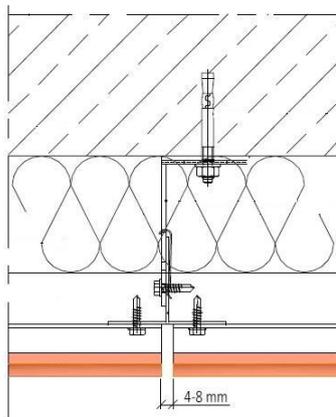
Sección horizontal. FAVEKER® FV. Sistema perfil horizontal.
